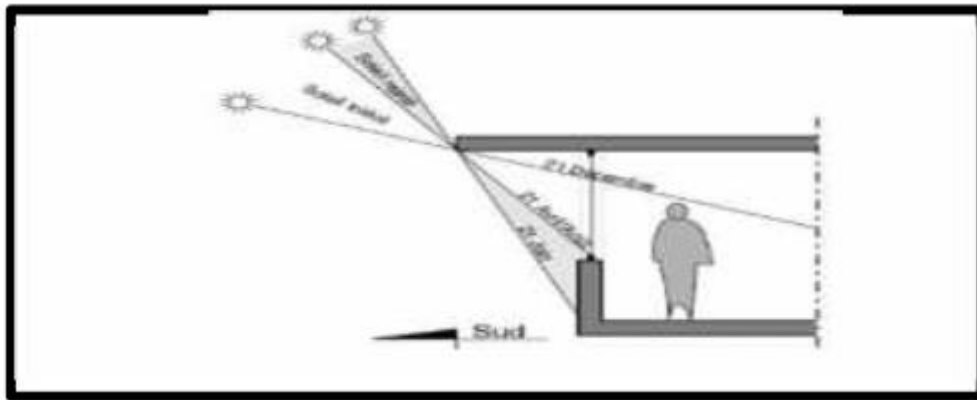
Protection fixe par une avancée de toit en façade sud.
